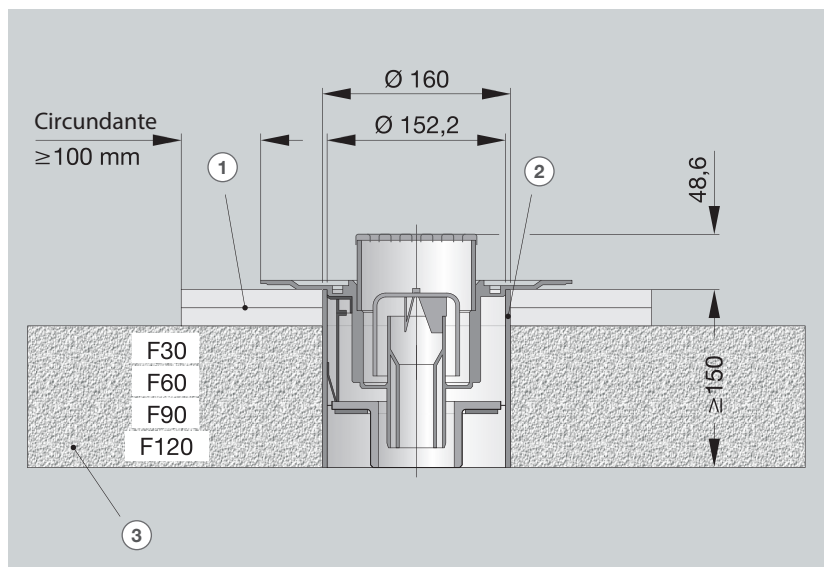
144 Sumidouro de pavimento Advantix R120 – Em orifício nuclear com placas de estrutura do pavimento
